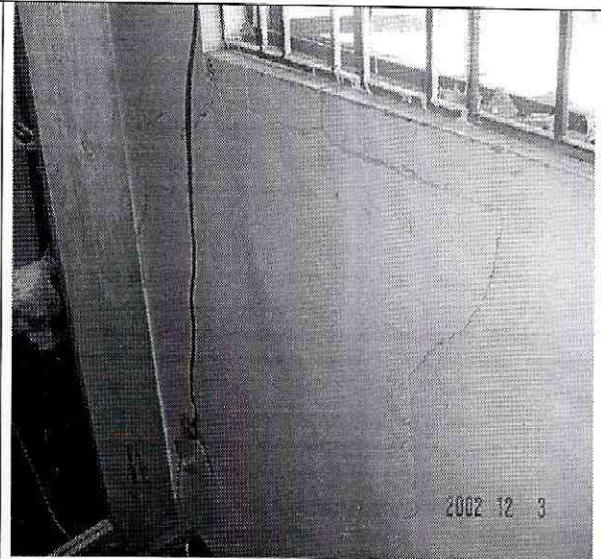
Agrietamientos muro fachada en segundo piso.
